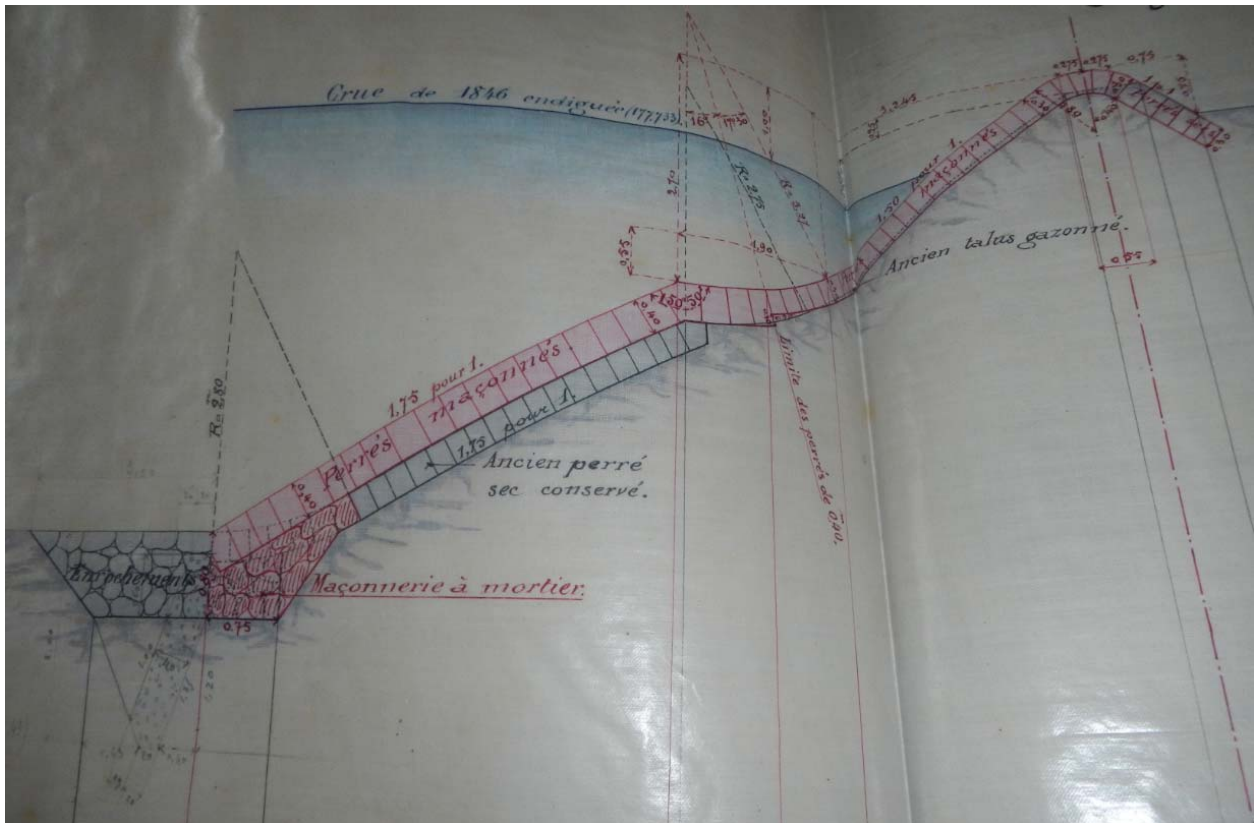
Profil type de la levée du canal de la Jonction avant et après travaux d'exhaussement et de consolidation exécutés côté Loire entre 1879 et 1882 – Source : Archives DDT 58
